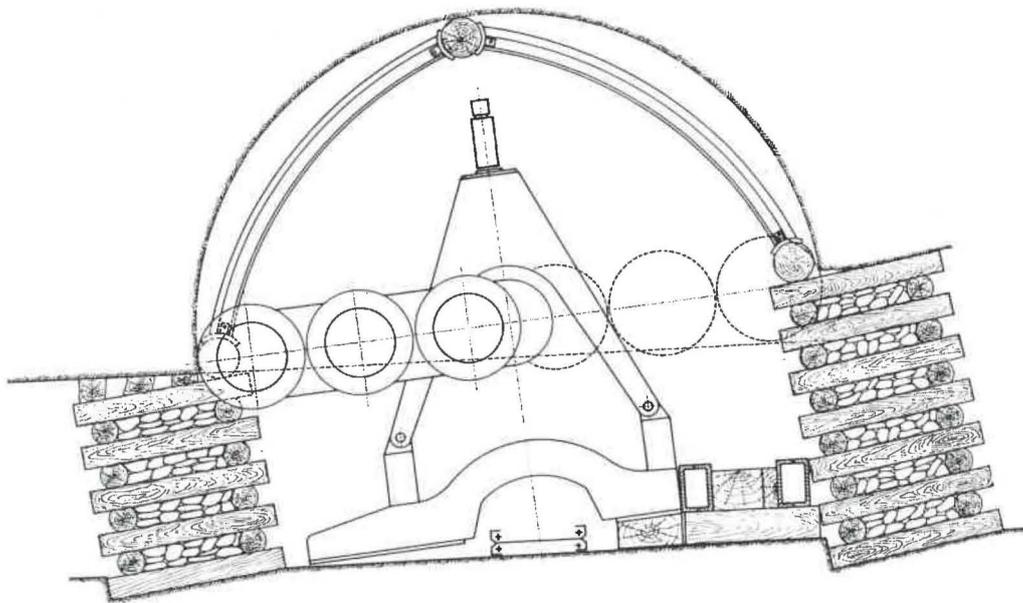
Soutènement définitif de la voie après creusement de la section par la machine. Ce soutènement est constitué par des cadres articulés sur piles de bois. Les 3 longrines en bois solidarissant les éléments des cadres entre eux ont 1,80 m ou 2,10 m de longueur. Au début des essais, lorsque la pente était de 16°, le convoyeur passait sous la machine et deux trémies, amont et aval, guidaient les déblais vers le convoyeur. Le guidage latéral de la machine était effectué au début au moyen de poutrelles et de coins en bois. Actuellement (voir aussi figure 6), le convoyeur se trouve à l'aval et le guidage latéral de la machine est effectué à l'aide de 2 vérins prenant appui contre les piles aval. Une grande trémie de 1,20 m de largeur dirige les déblais vers le convoyeur.
